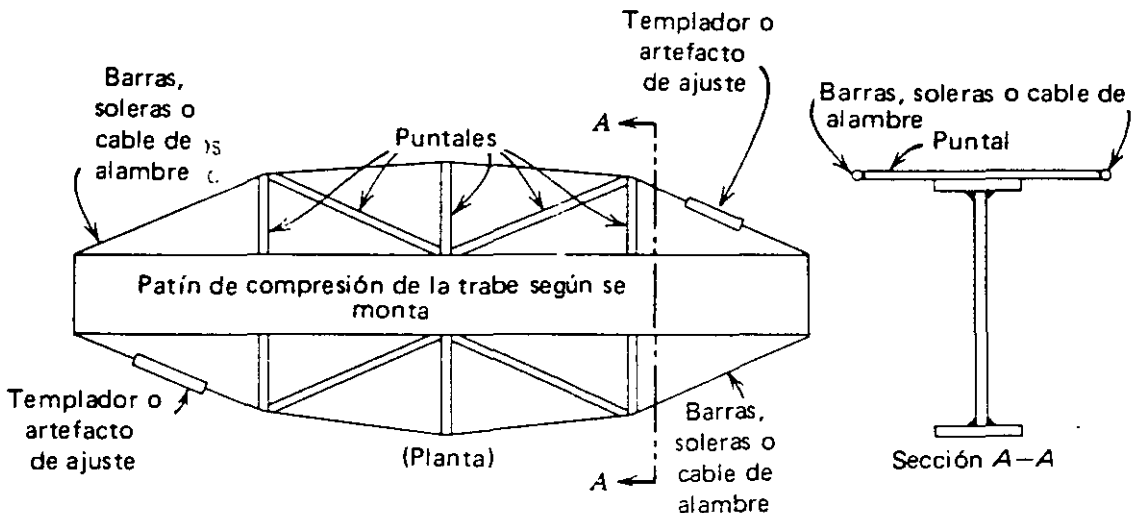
Atirantamiento. Distribución esquemática, mostrando el atirantamiento de una trabe lateralmente inestable.
